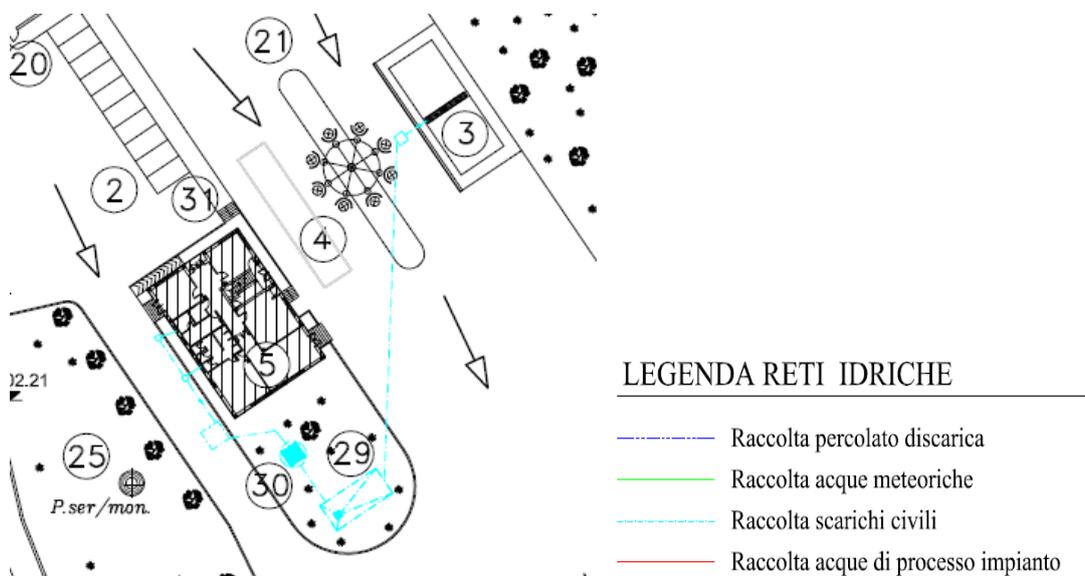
Stralcio da Allegato 6 – Planimetria reti e scarichi – reflui civili e lavaggio mezzi
